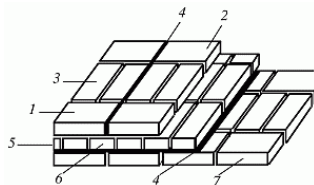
Элементы каменной кладки: 1 – наружная верста; 2 – внутренняя верста; 3 – забутка; 4 – горизонтальный и вертикальный швы; 5 – фасад; 6 – тычковый ряд; 7 – ложковый ряд
